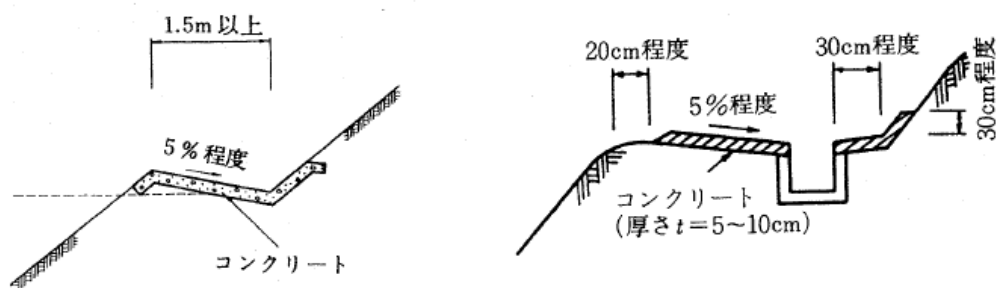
コンクリート排水溝及び鉄筋コンクリートU形溝の例（小段排水）
